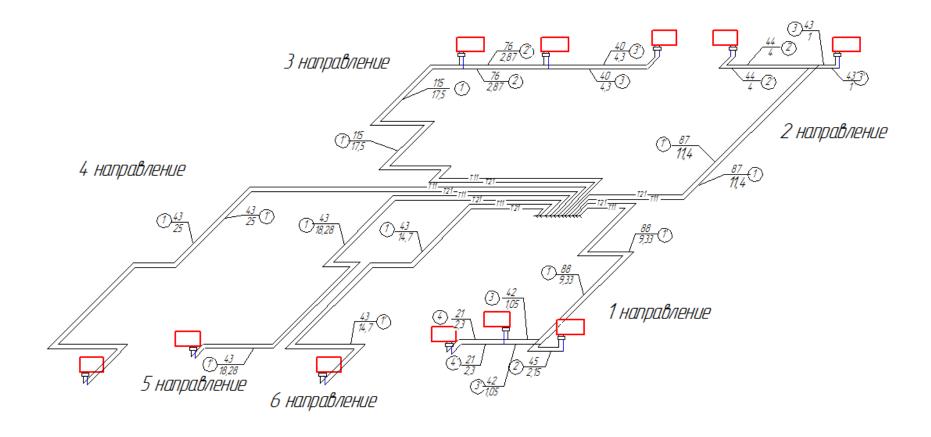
Расчетная схема поквартирной разводки 1,3 этажа (БС-1)
